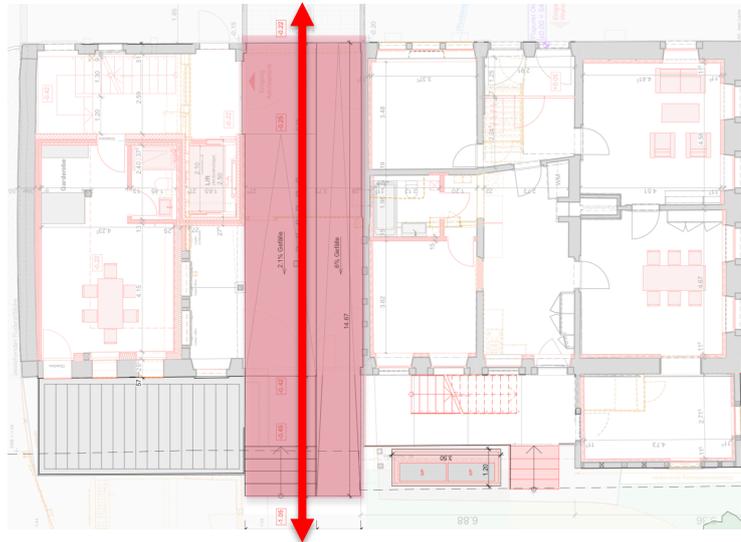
Ansicht EG Bauernhaus mit Passage (rot eingefärbt).
